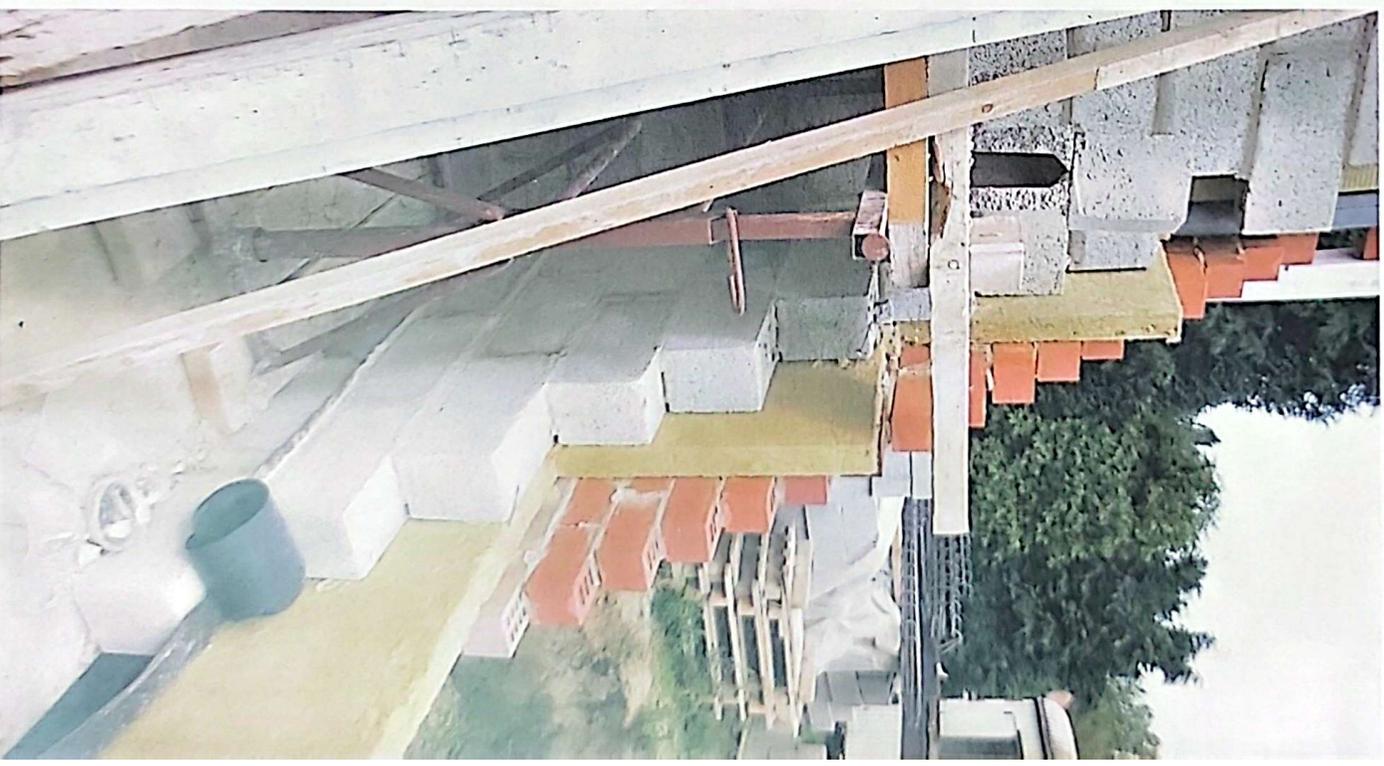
La succession des composants d'un mur porteur en façade, 14 cm de blocs de béton, 6 cm de laine de verre, 9 cm de brique de parement.
